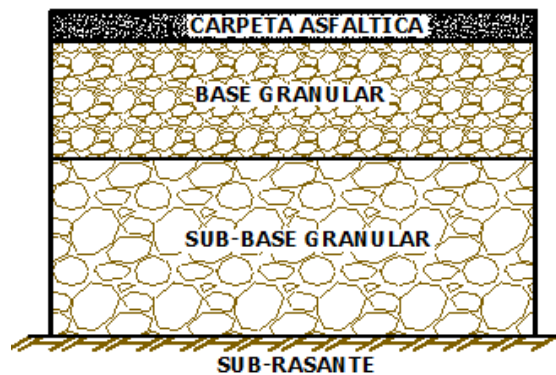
Sección típica de un pavimento flexible de hormigón asfáltico (carpeta).
